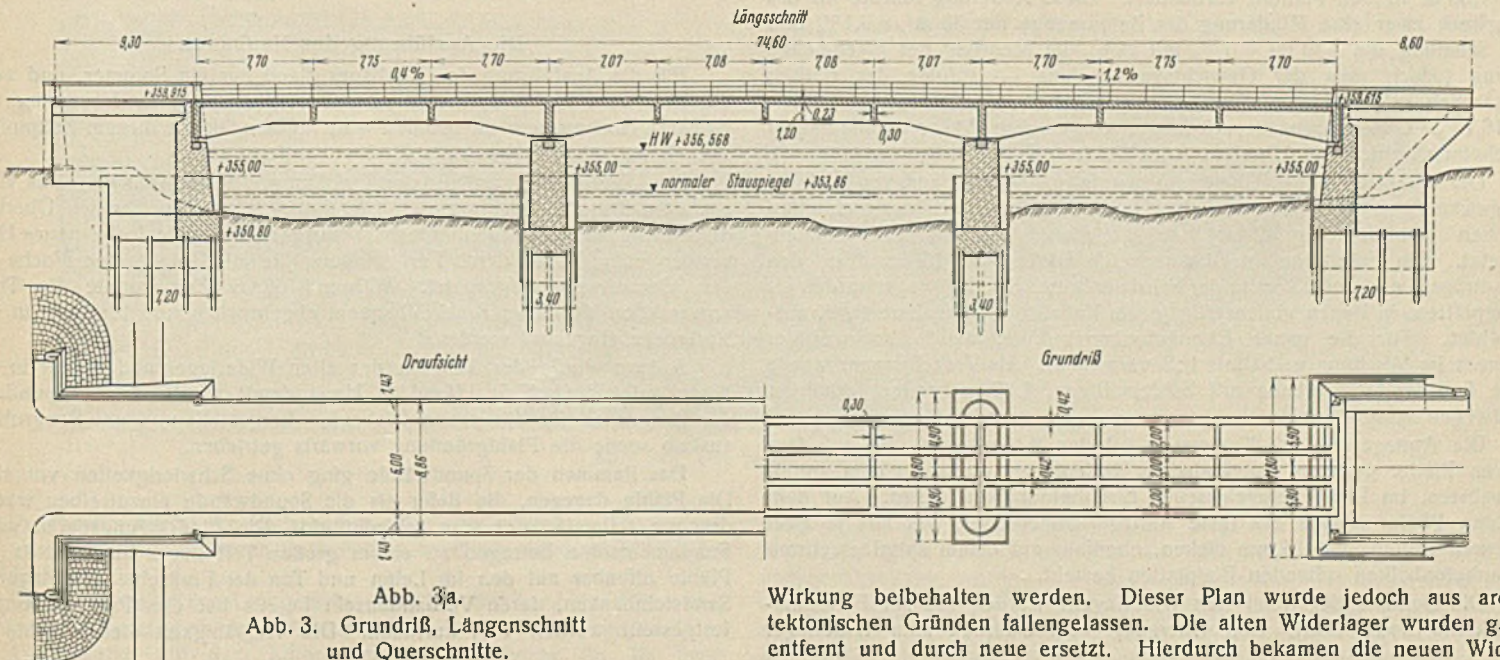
Grundriß, Längsschnitt und Querschnitte.
